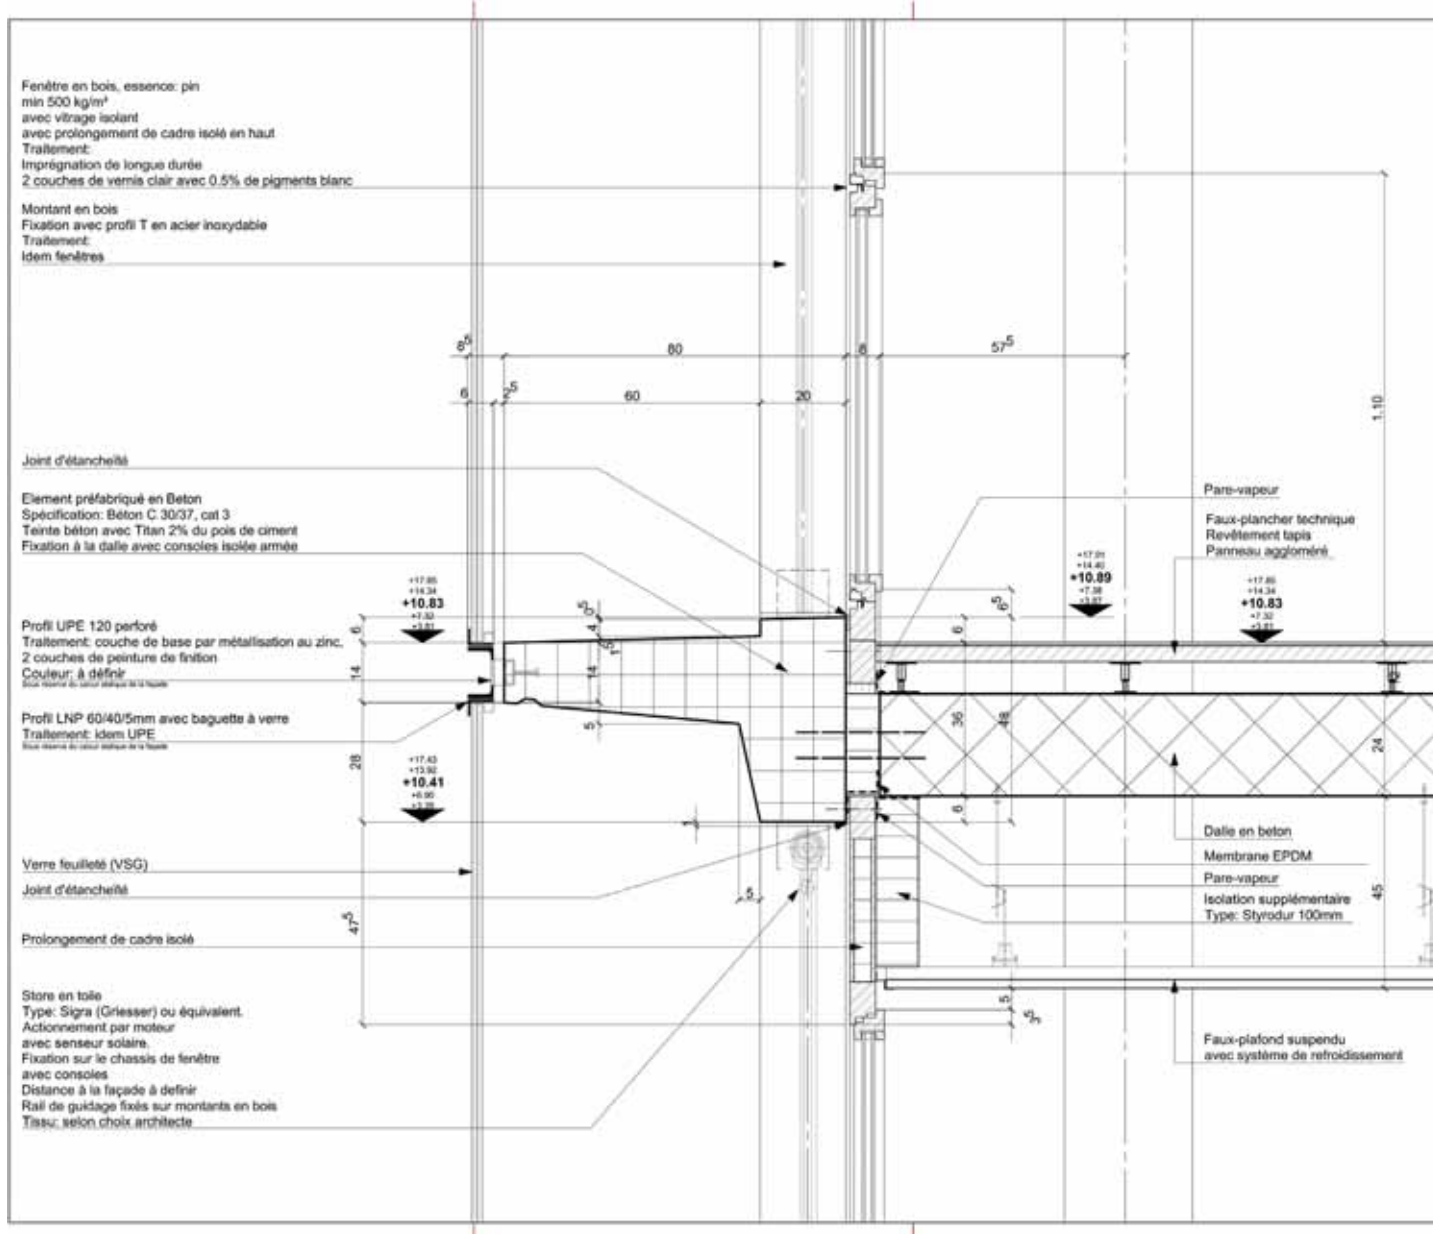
Stralcio progetto architettonico sezione verticale facciata a doppia pelle
